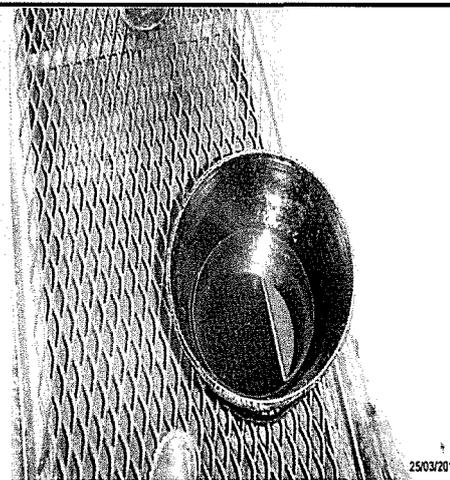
E0373735 N9723756/ Taller de Llantería y Lubricación.
